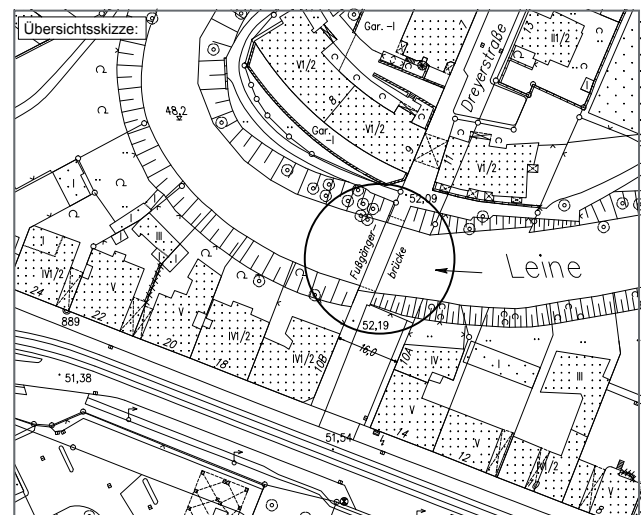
Lageplan der Brücke in der Calenberger Neustadt
